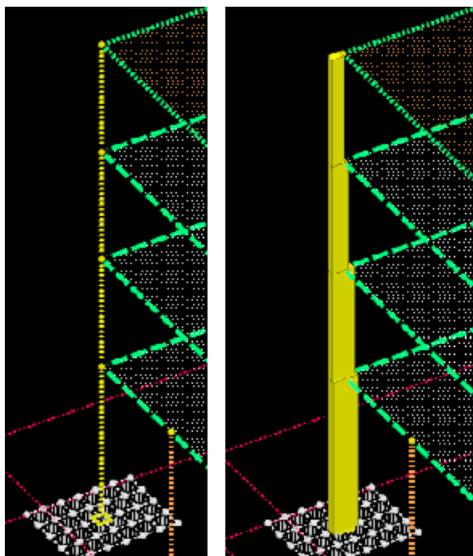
pilastro analitico e ingombri del pilastro nel CAD3D di DOLMEN
